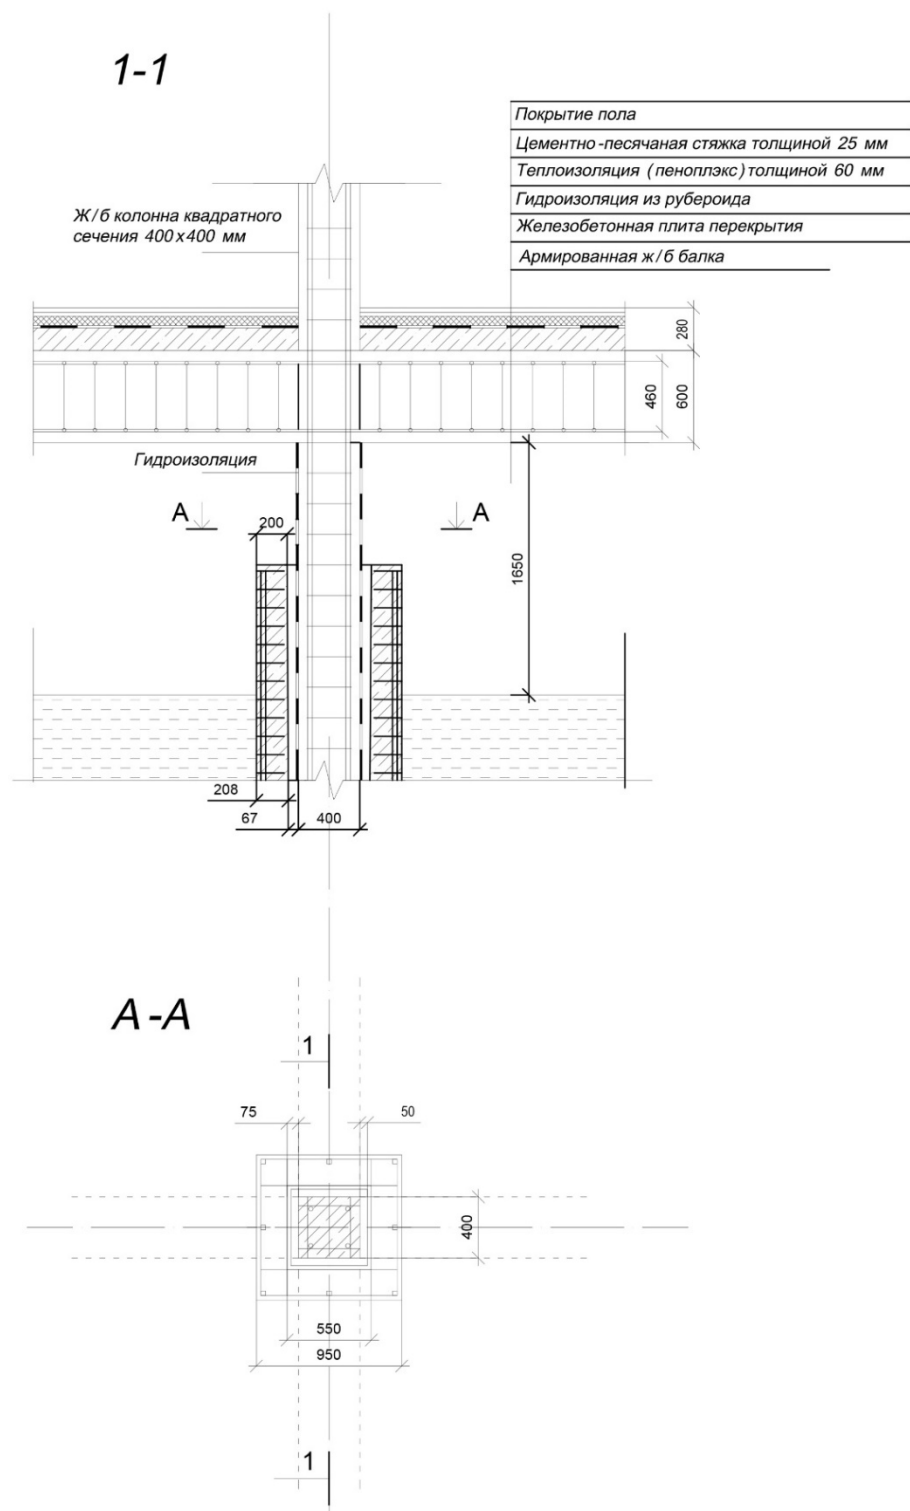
Узел пересечения железобетонной колонны постоянного сечения по высоте с армированной железобетонной балкой.
